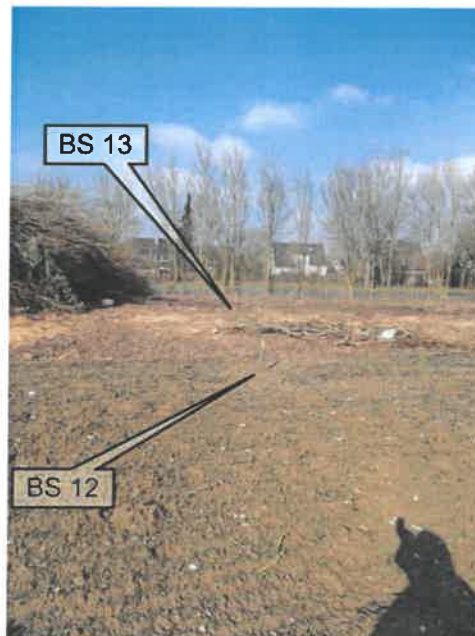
Blickrichtung ~ NNW; Bereich der BS 12 und BS 13 (Markierungen)
